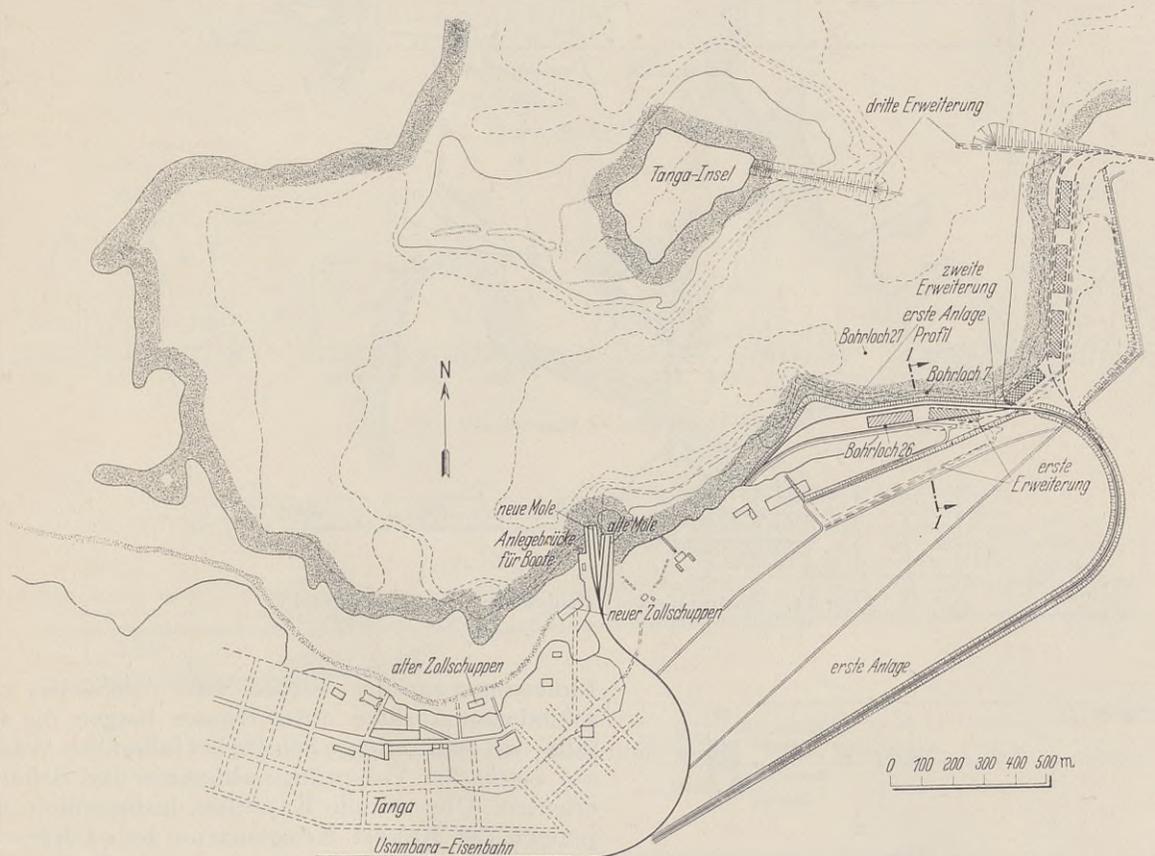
Lageplan von Tanga mit den geplanten Bauten.
